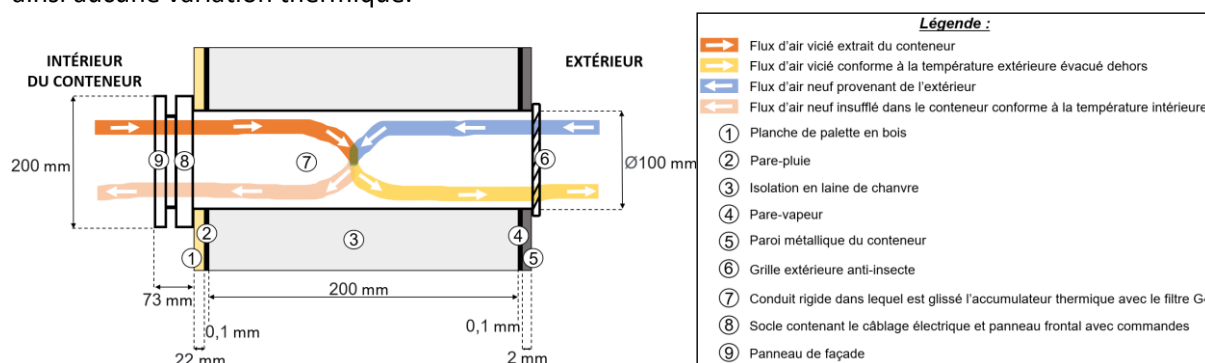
Plan de coupe de la ventilation sur la porte du conteneur
